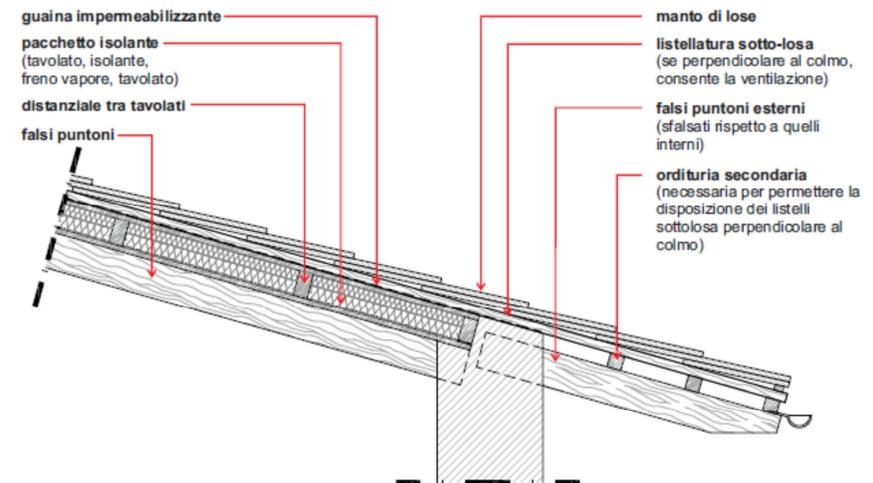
struttura a falsi puntoni con ventilazione sotto losa
